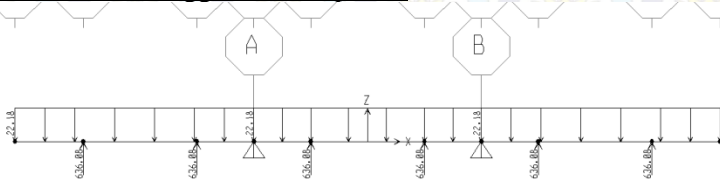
Analisa Poer Sebagai Balok Kantilever pada arah-y(lihat kiri) untuk P2
